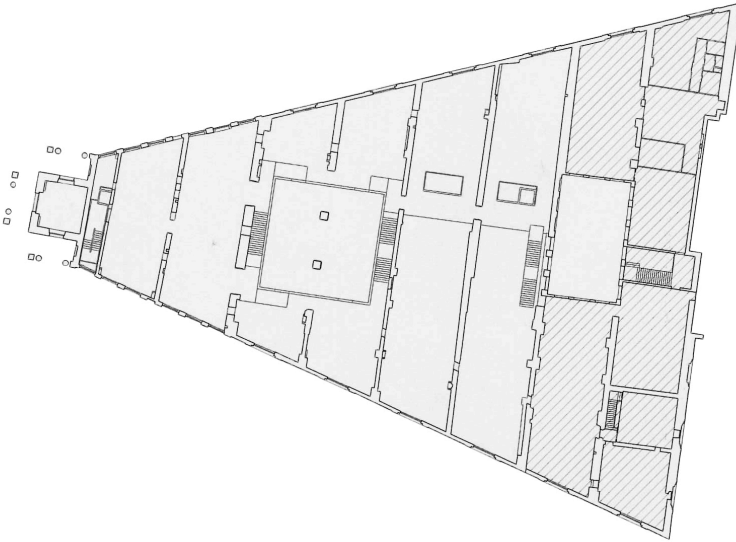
Grundriss des Obergeschosses *Punta della Dogana*, Tadao Ando.
